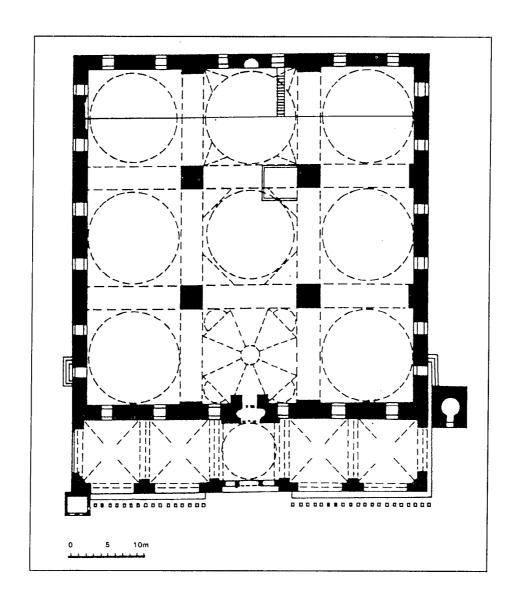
مسقط أفقي لمسجد لارى چلبى في أدرنة (عن :Yüksel) .
